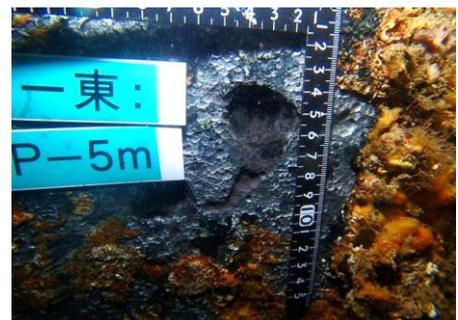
孔食状況 (2P 東側 T.P.-5.0m)
